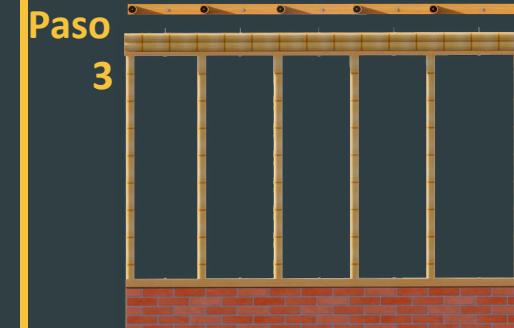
[Estrategia constructiva] Armado y montaje de muros. Fuente: Autor.
